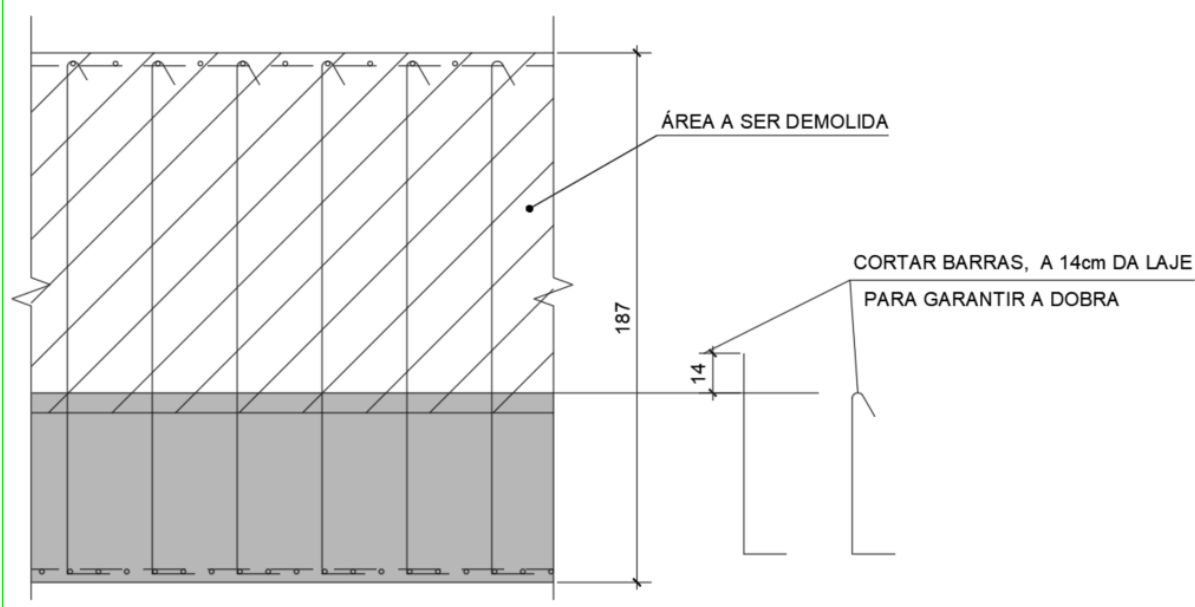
Detalhe típico para preservação e reconstrução da armadura de cisalhamento da laje de fundo do nicho da escada rolante.
